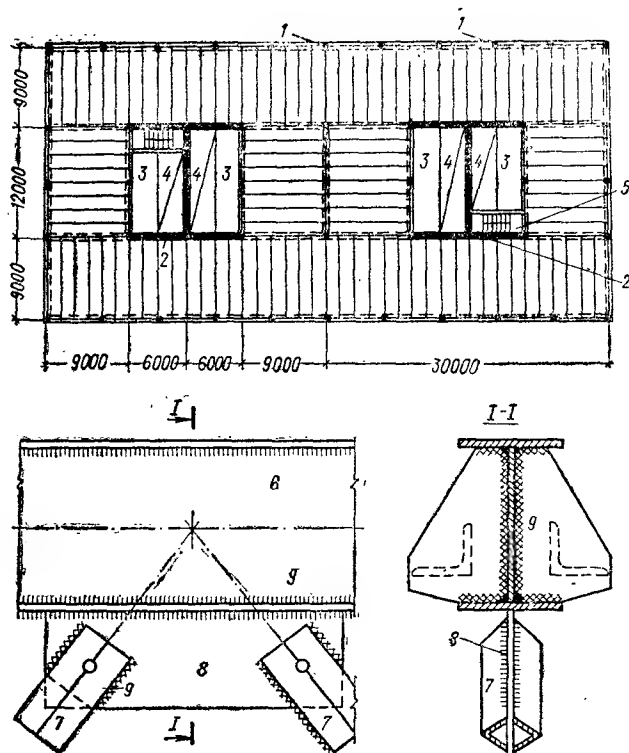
План несущего остова 40-этажного каркасного здания и узел примыкания связей к ригелю
